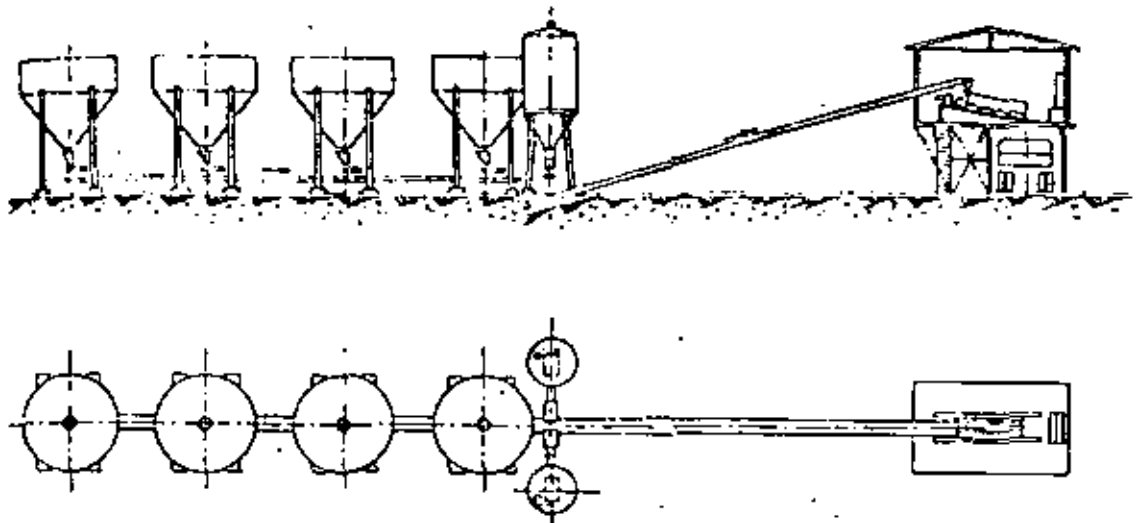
Planta central de concreto Autocrete (Europea).
